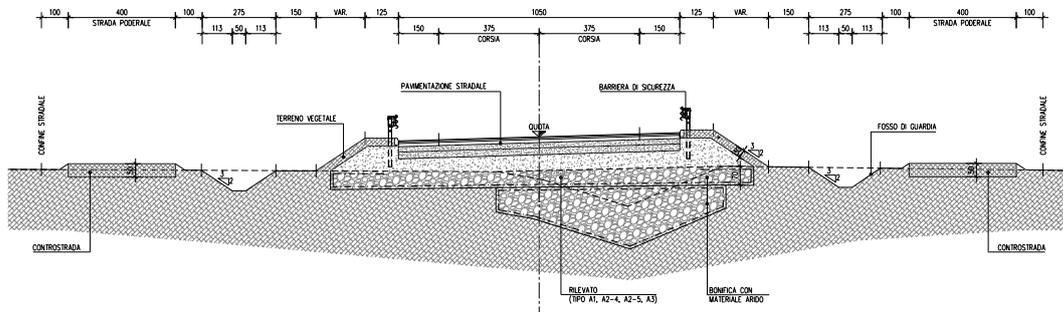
Tratto Svincolo di Vigasio - Svincolo di Buttapietra - Sezione Tipo
